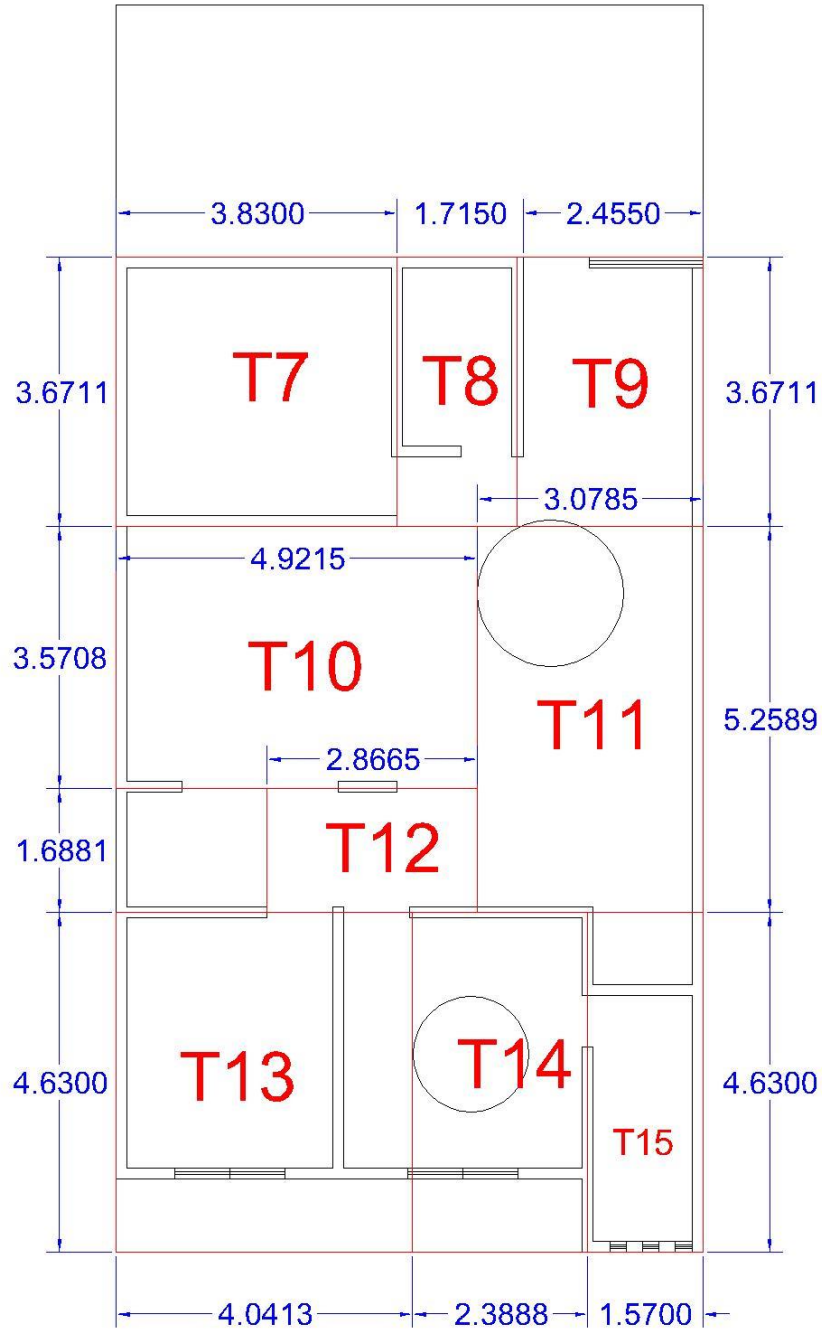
Distribución de tableros en planta alta (acotaciones en metros).
